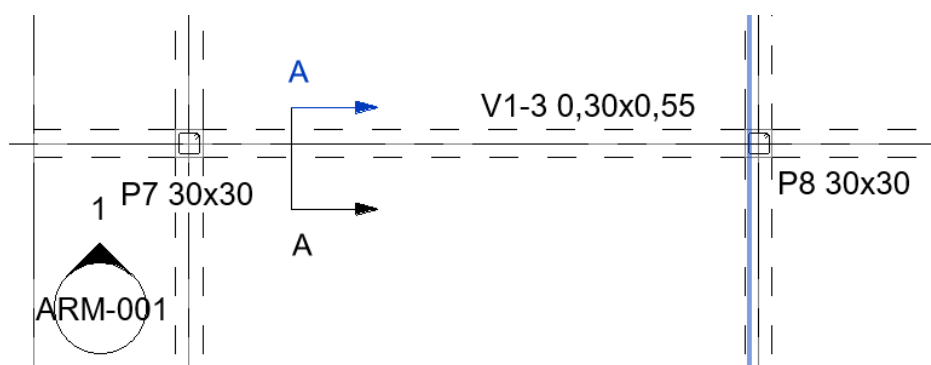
Exemplo de elevação e corte da viga V1-3.
